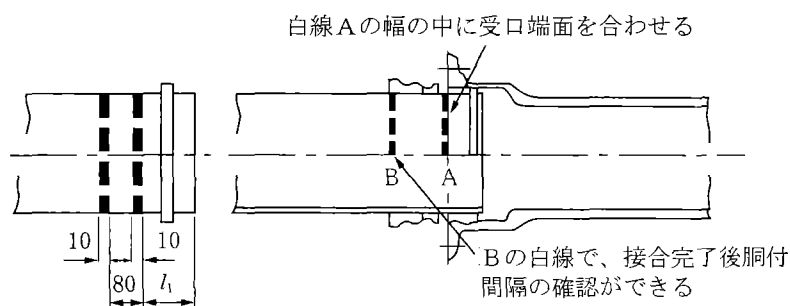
受口・挿し口の挿入完了 (単位: mm)
